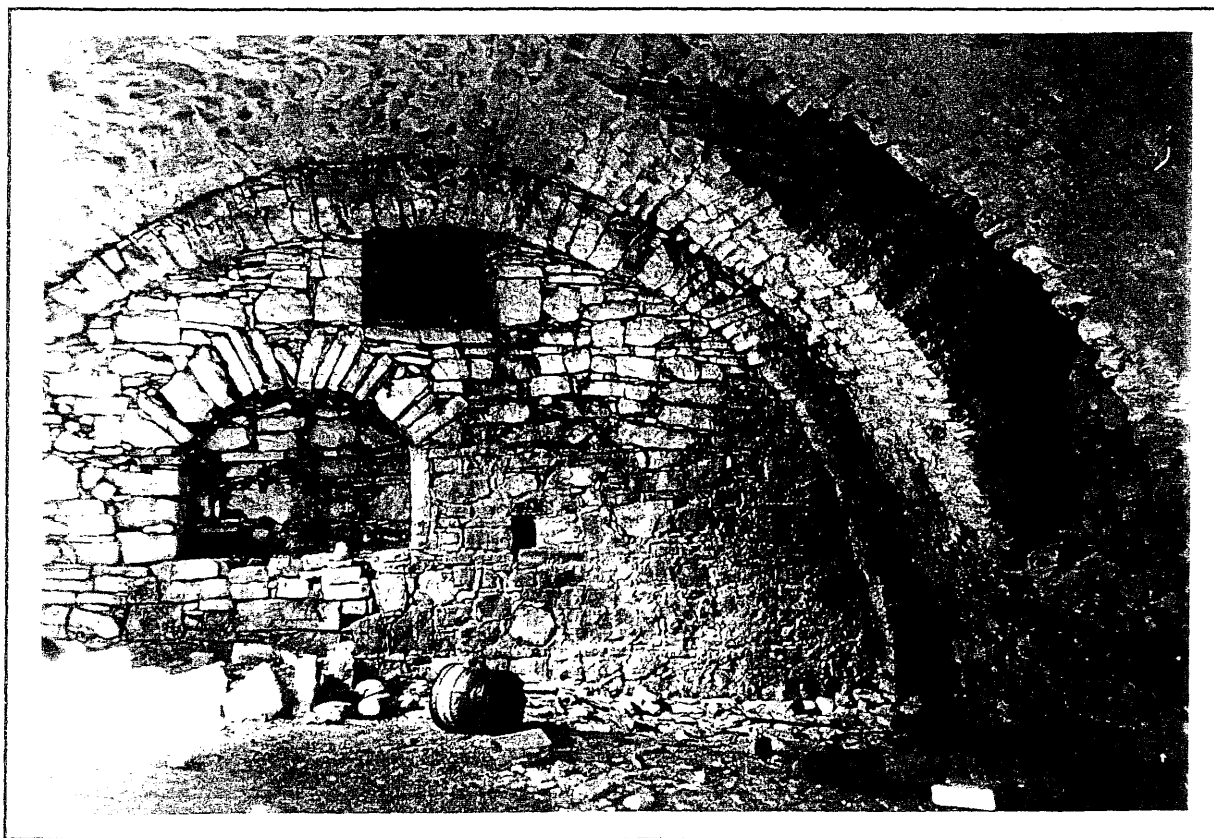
CASCINA PANARI. PIANO INTERRATO: PARTICOLARE VOLTE IN PIETRA
